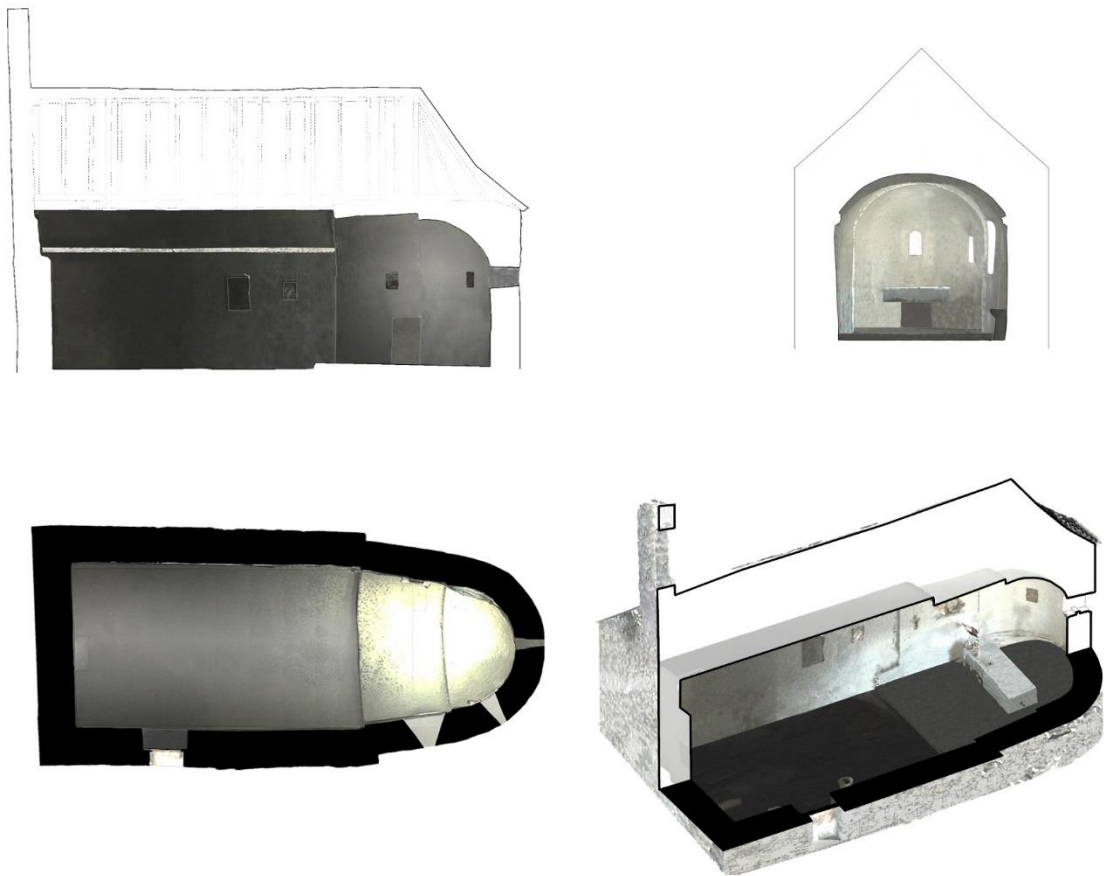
Planimetría de Sant Joan d'Arres de Jos. e.:1/200
